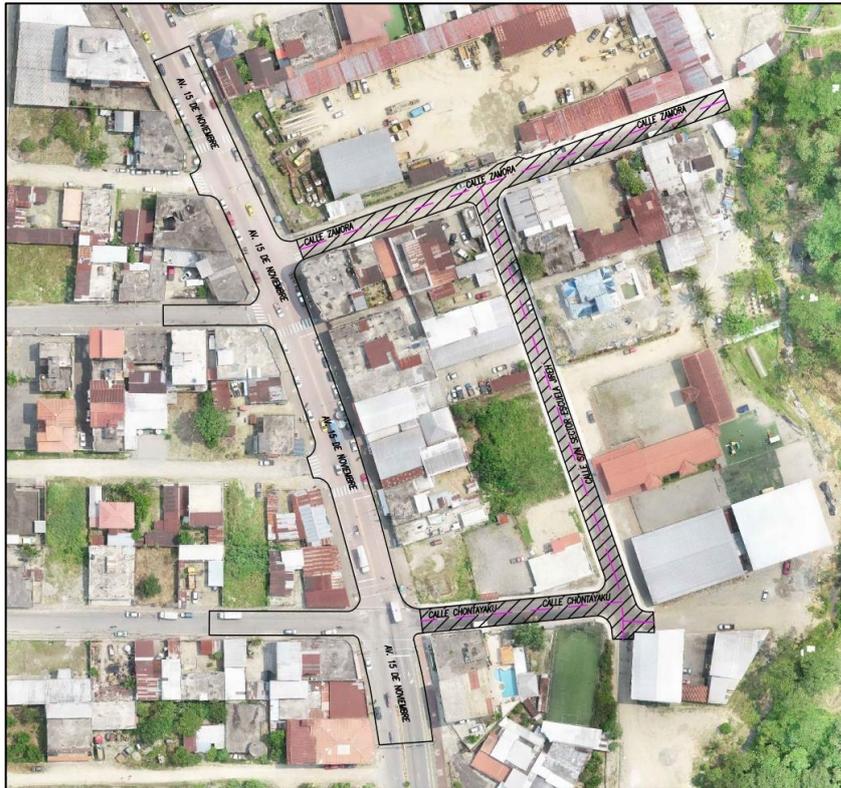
Vista en planta de los accesos al sitio de asfaltado
